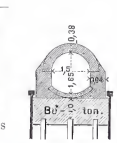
Schnitt a-b des Grundrisses.
